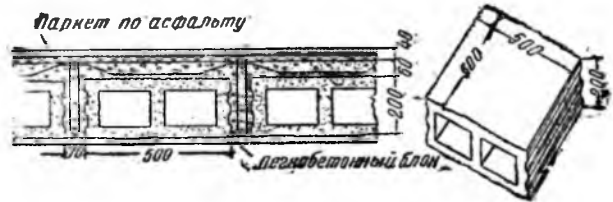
Пустотелые легкобетонные блоки для железобетонных перекрытий
